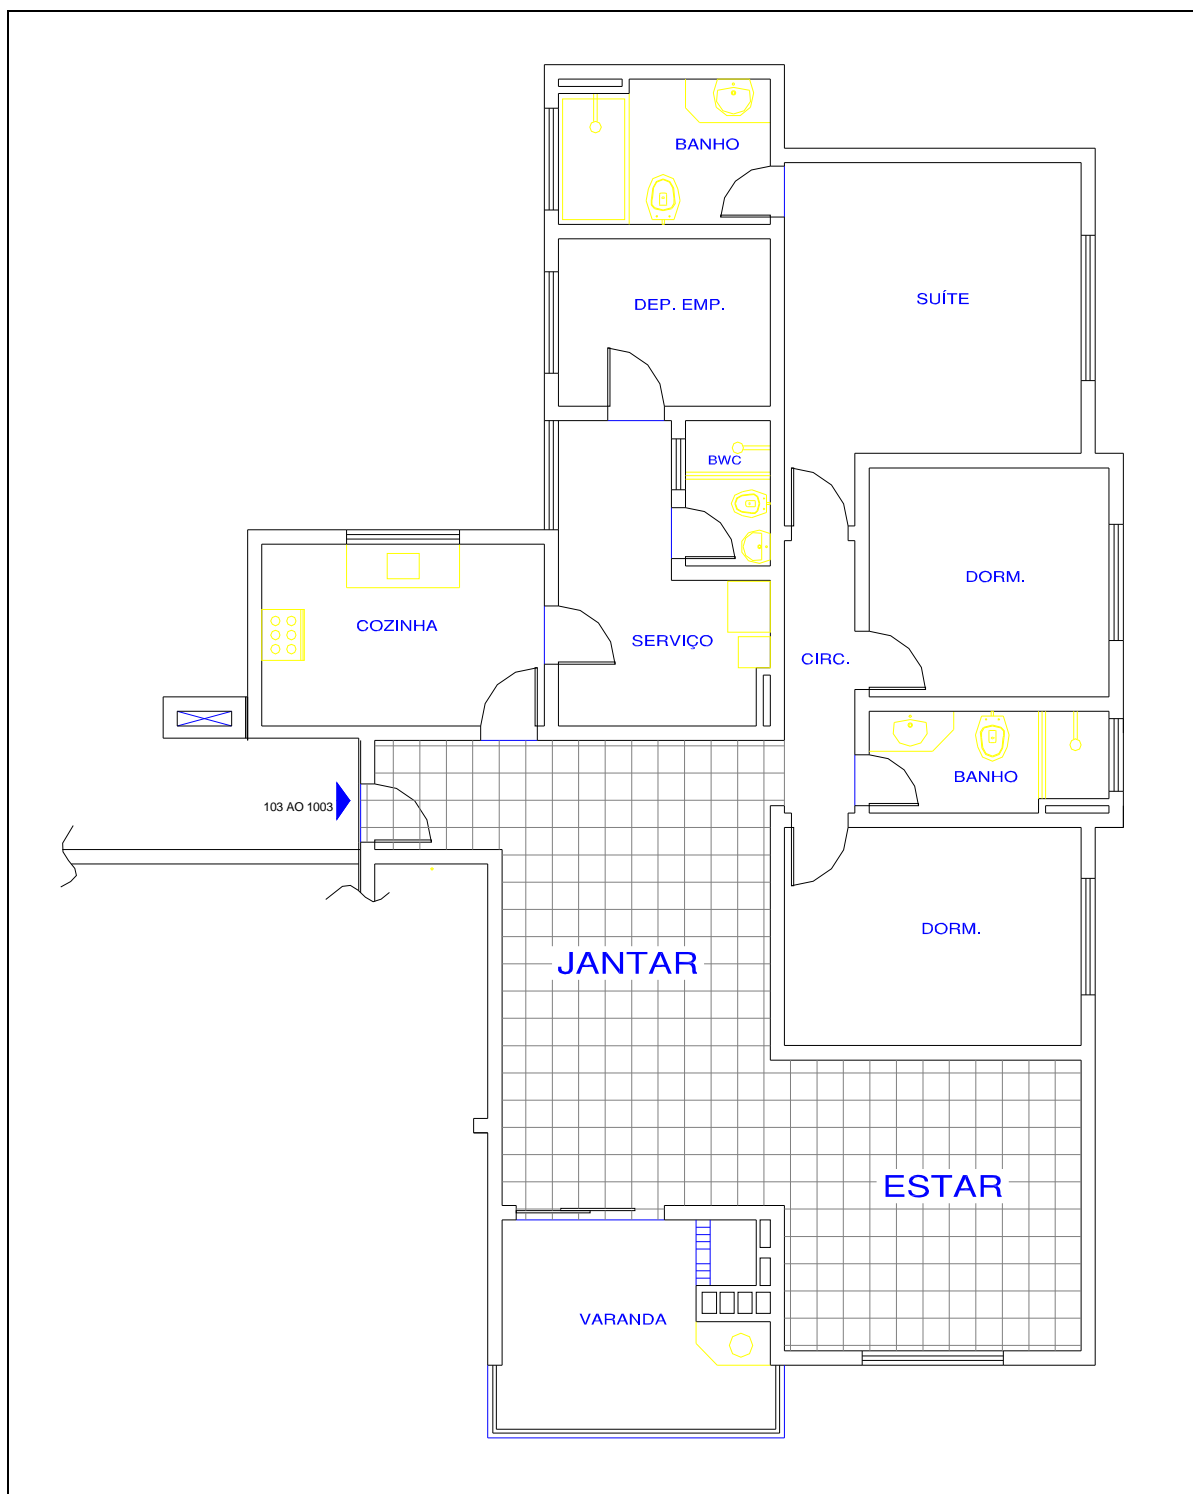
Planta baixa dos apartamentos 103 a 1003.
